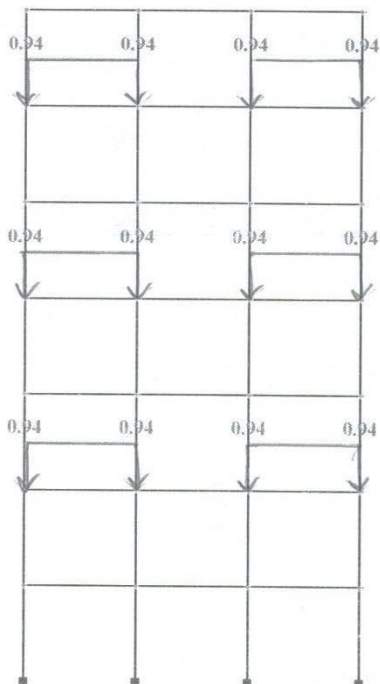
Схема завантаження рами у крайніх прольотах по нечотним поверхам навантаження від людей та устаткування.
